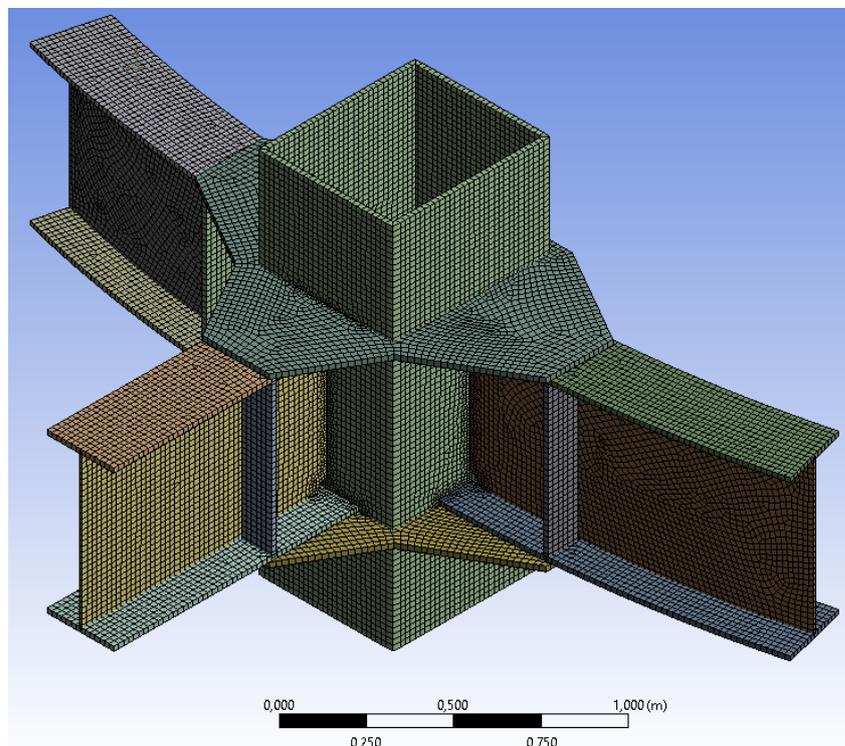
35: Mallado del conjunto con la placa de reforzamiento
